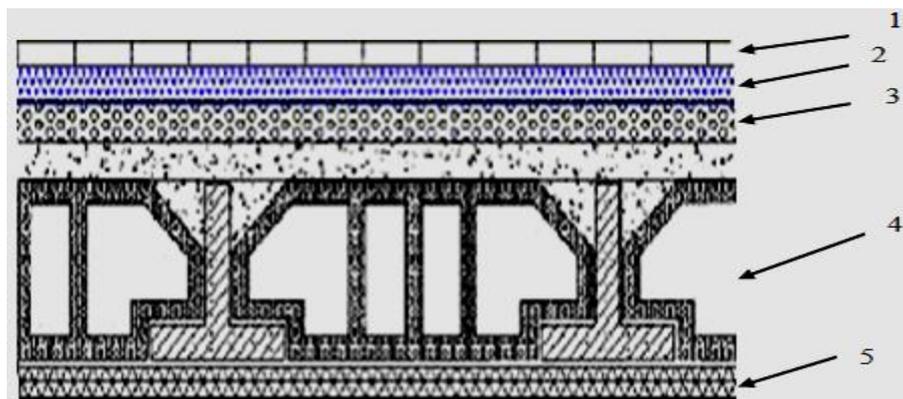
coupe d'un plancher à corps creux du plancher étage courants
